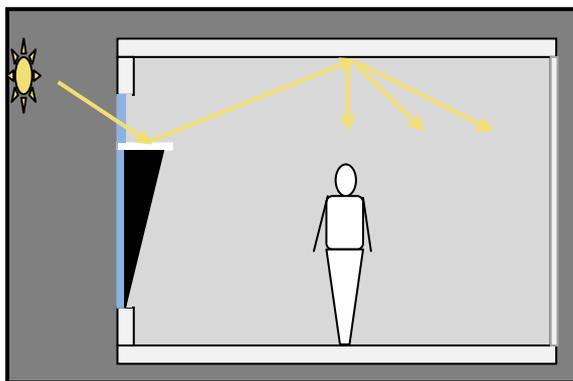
Façade avec dispositif d'ombrage intérieur. (Source : Auteur)
